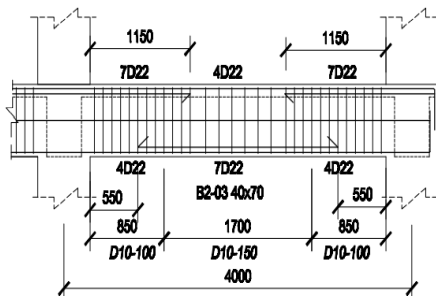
(a) Balok B3 (b) Tulangan Balok B3
